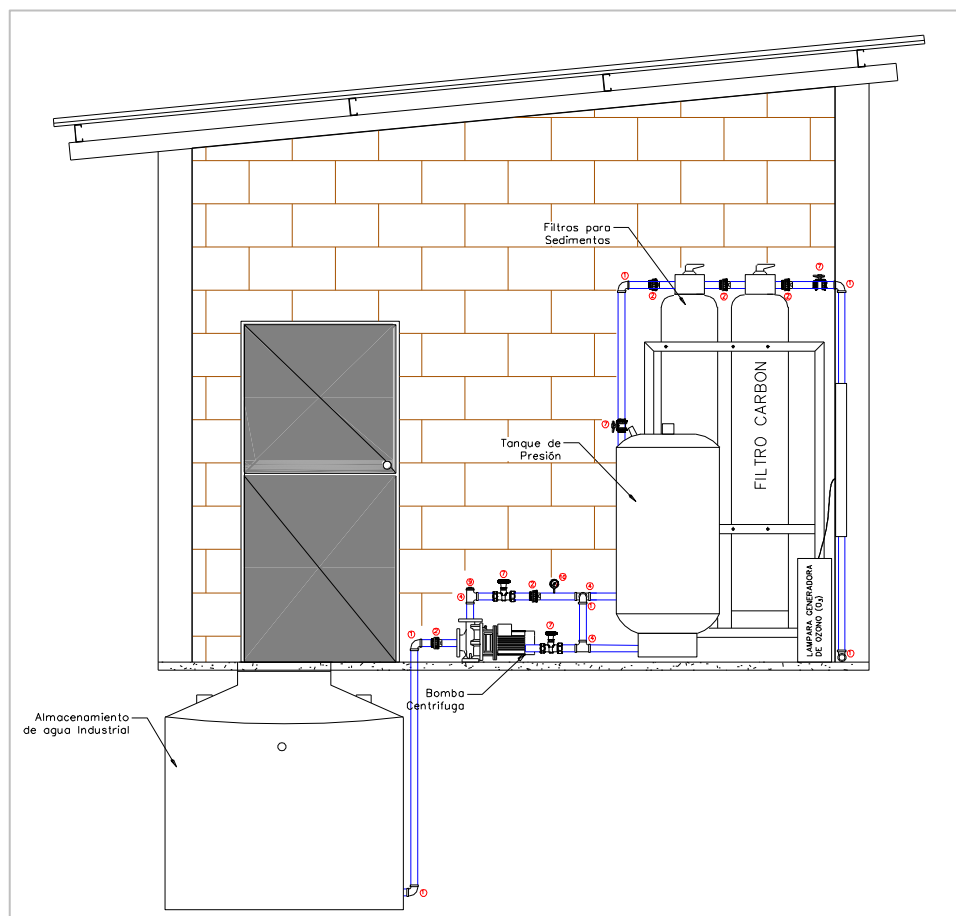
Vista Lateral de la Planta de Tratamiento
